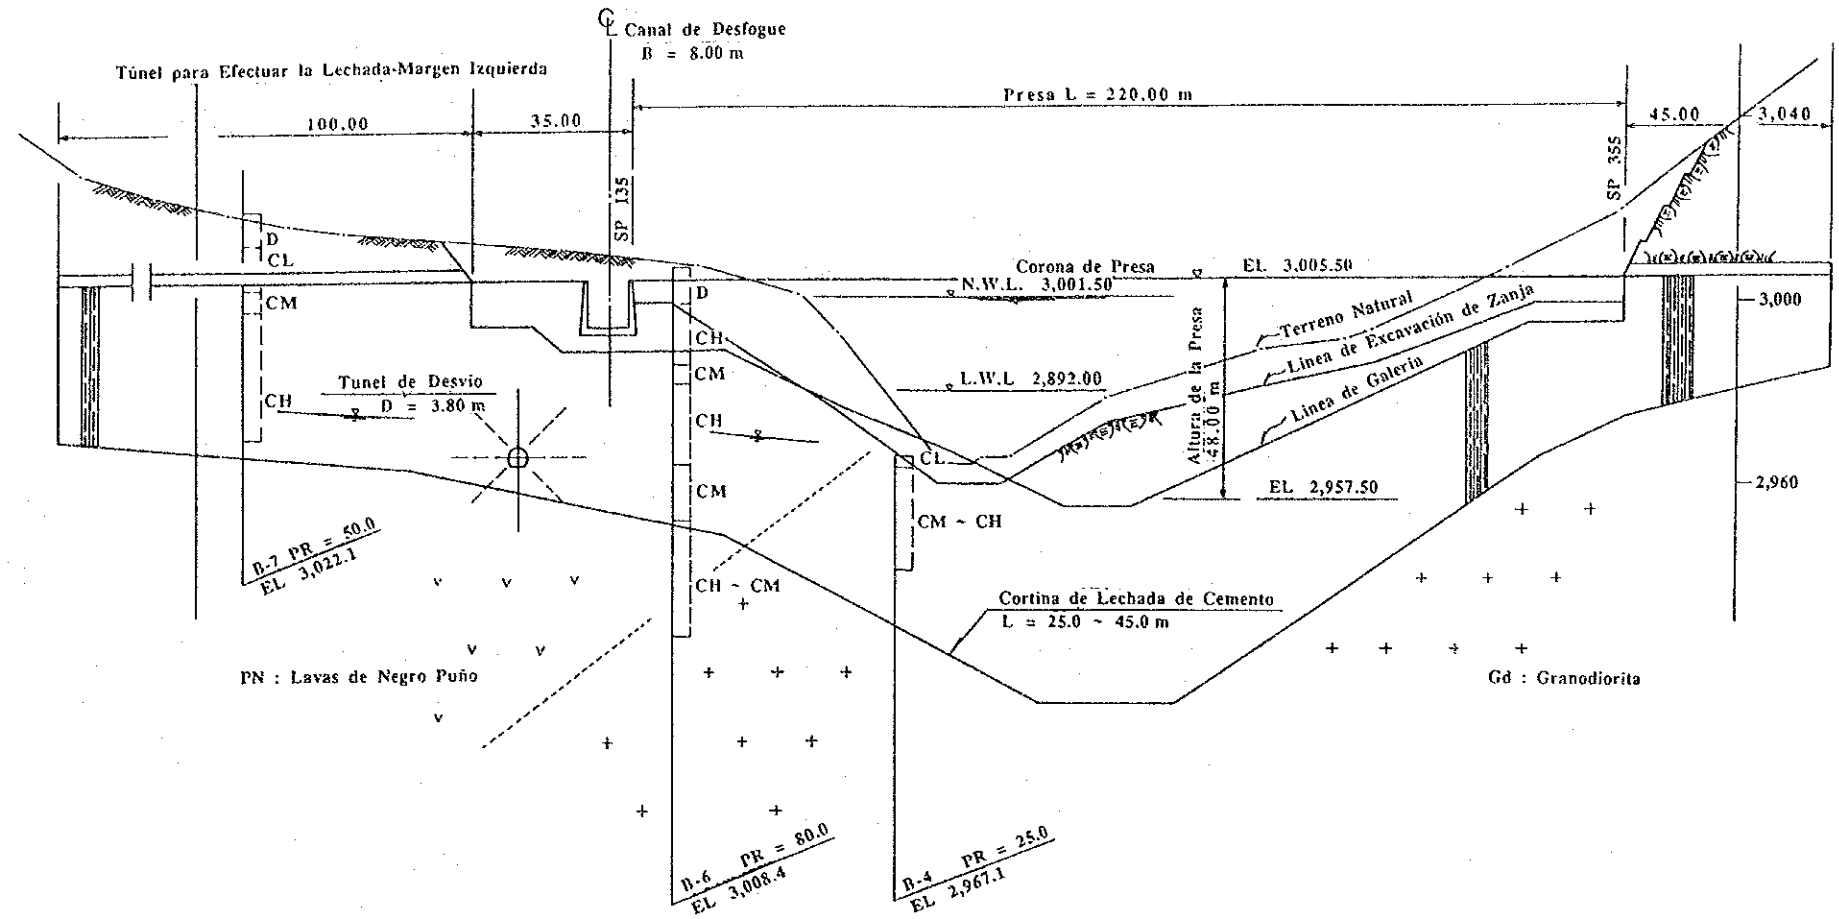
Sección Longitudinal y Transversal de la Presa Propuesta
